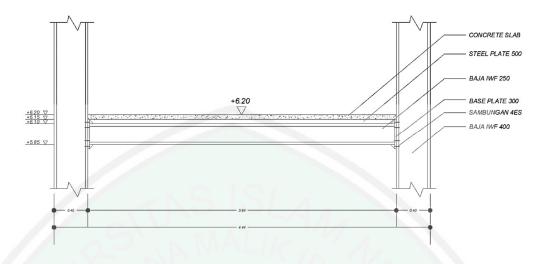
Denah rencana pembalokan lantai 3 berjenis baja
